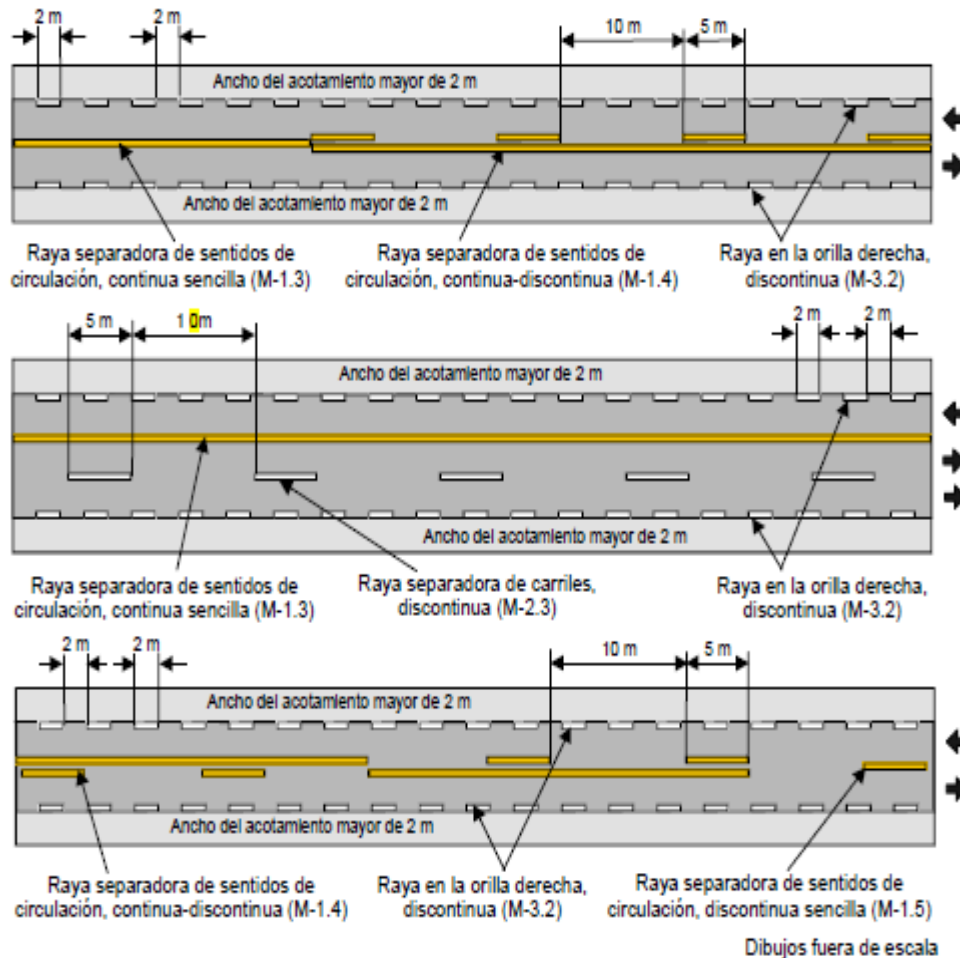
Marcas en el pavimento en carreteras con ancho de arroyo vial mayor de 6,5 m
